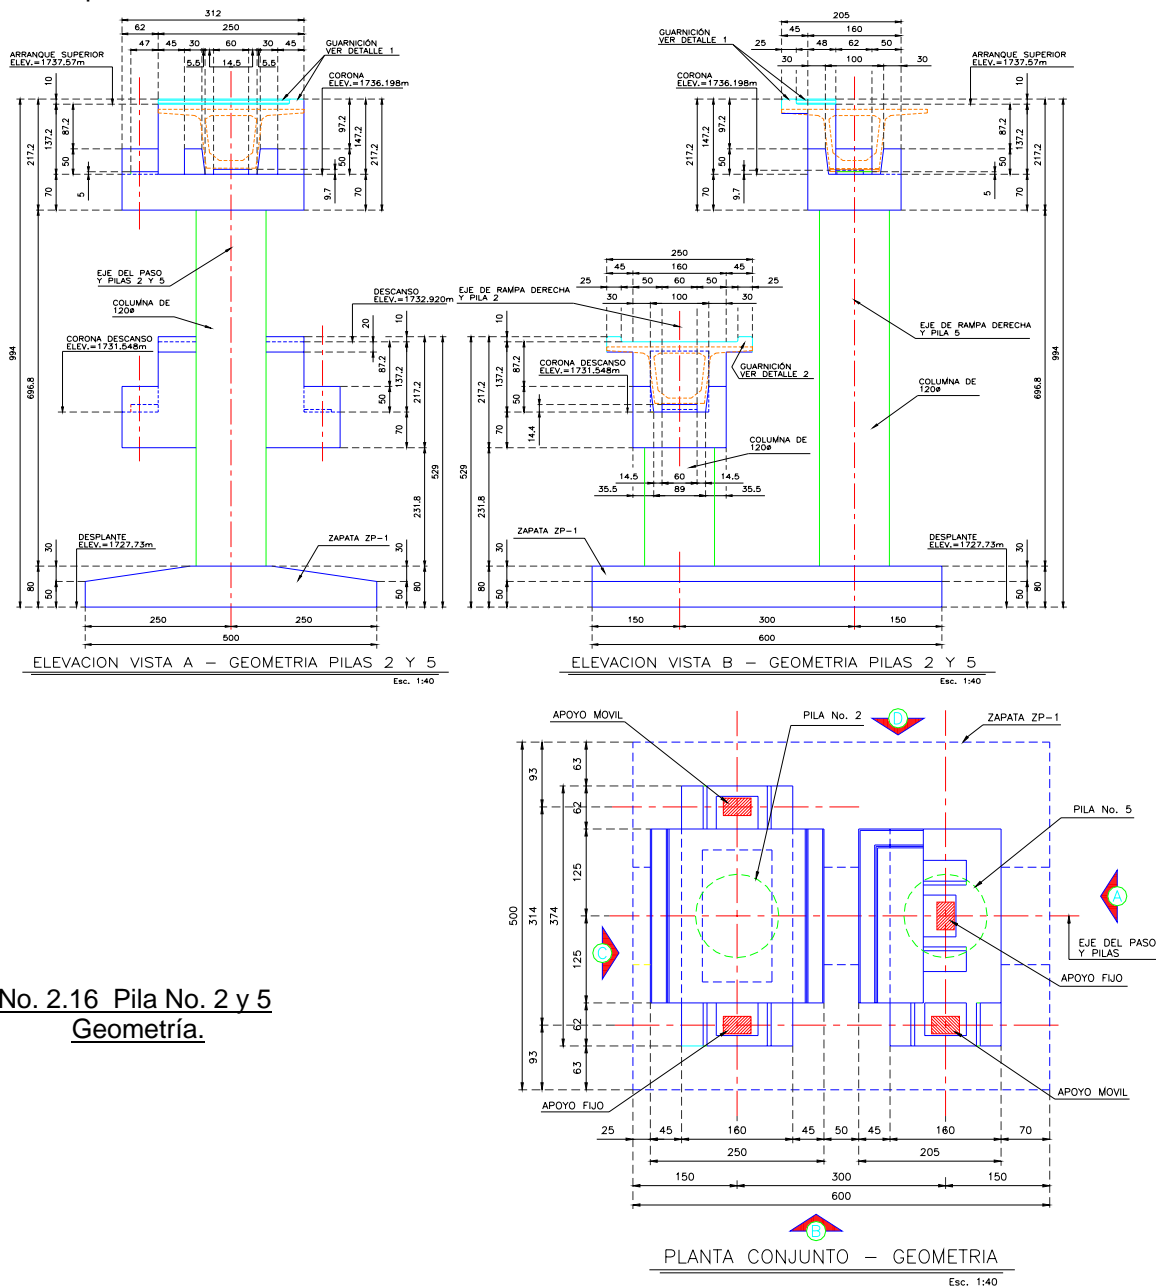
Pila No. 2 y 5 Geometría.
